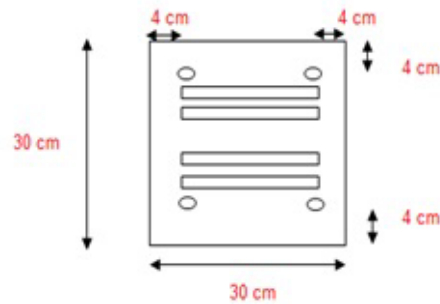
Vista de planta de placa de apoyo para cerchas.
